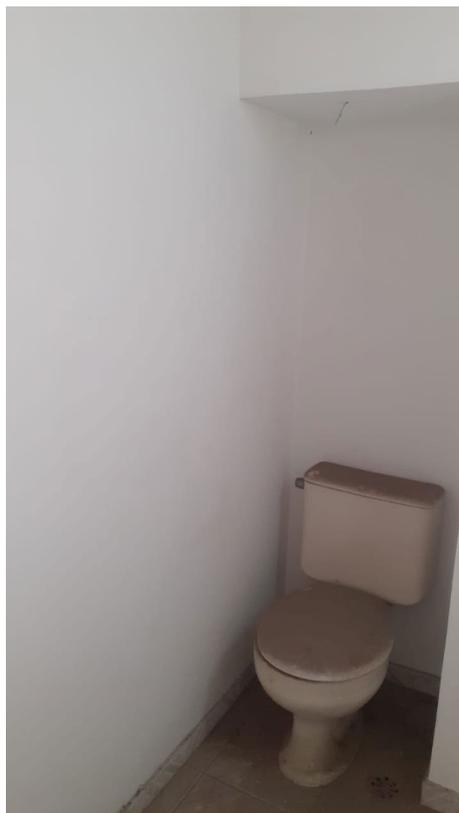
Vista do banheiro do 2º pavimento do imóvel periciando.
